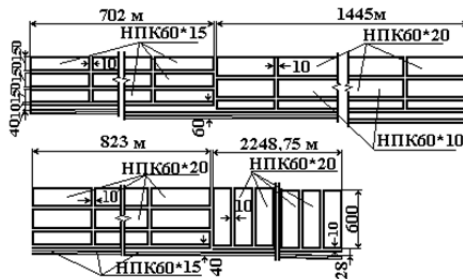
Розкладка збірних залізобетонних плит на укосах каналу
